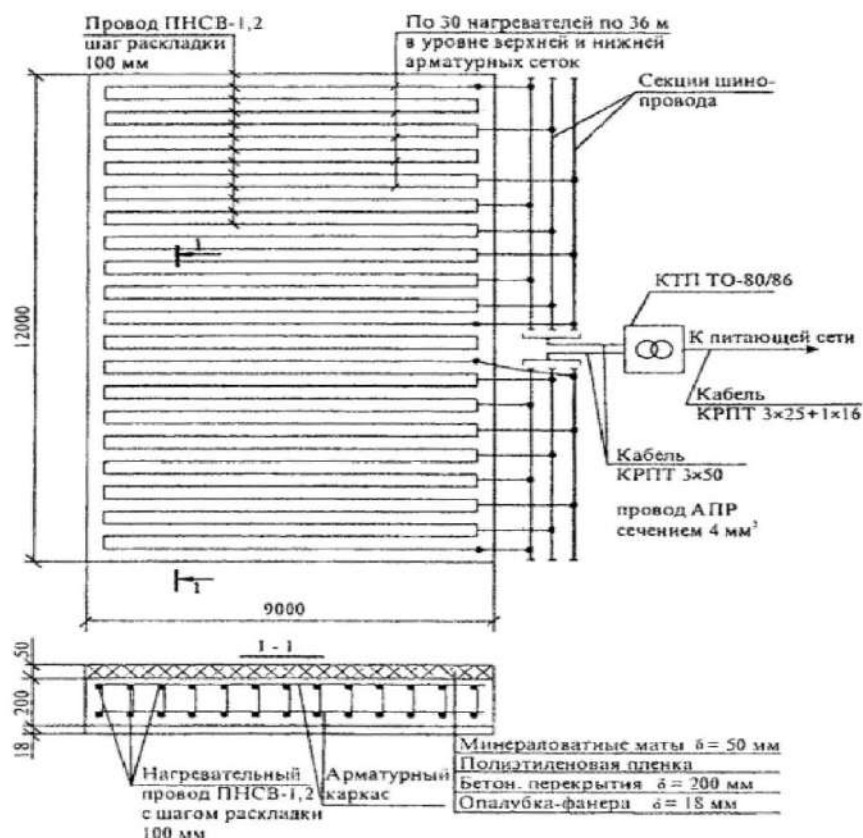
Схема раскладки и подключения нагревательного провода про электрообогреве перекрытия
